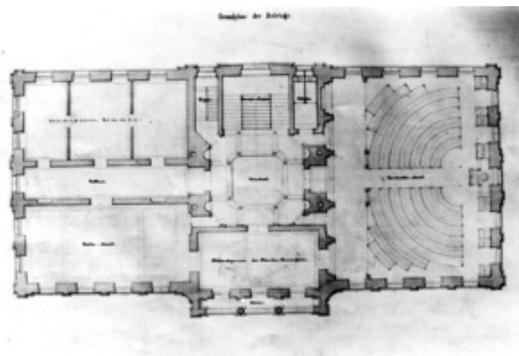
Glarus, Regierungsgebäude, Plan 3, Grundriss Belétage, Vorprojekt, 1862
